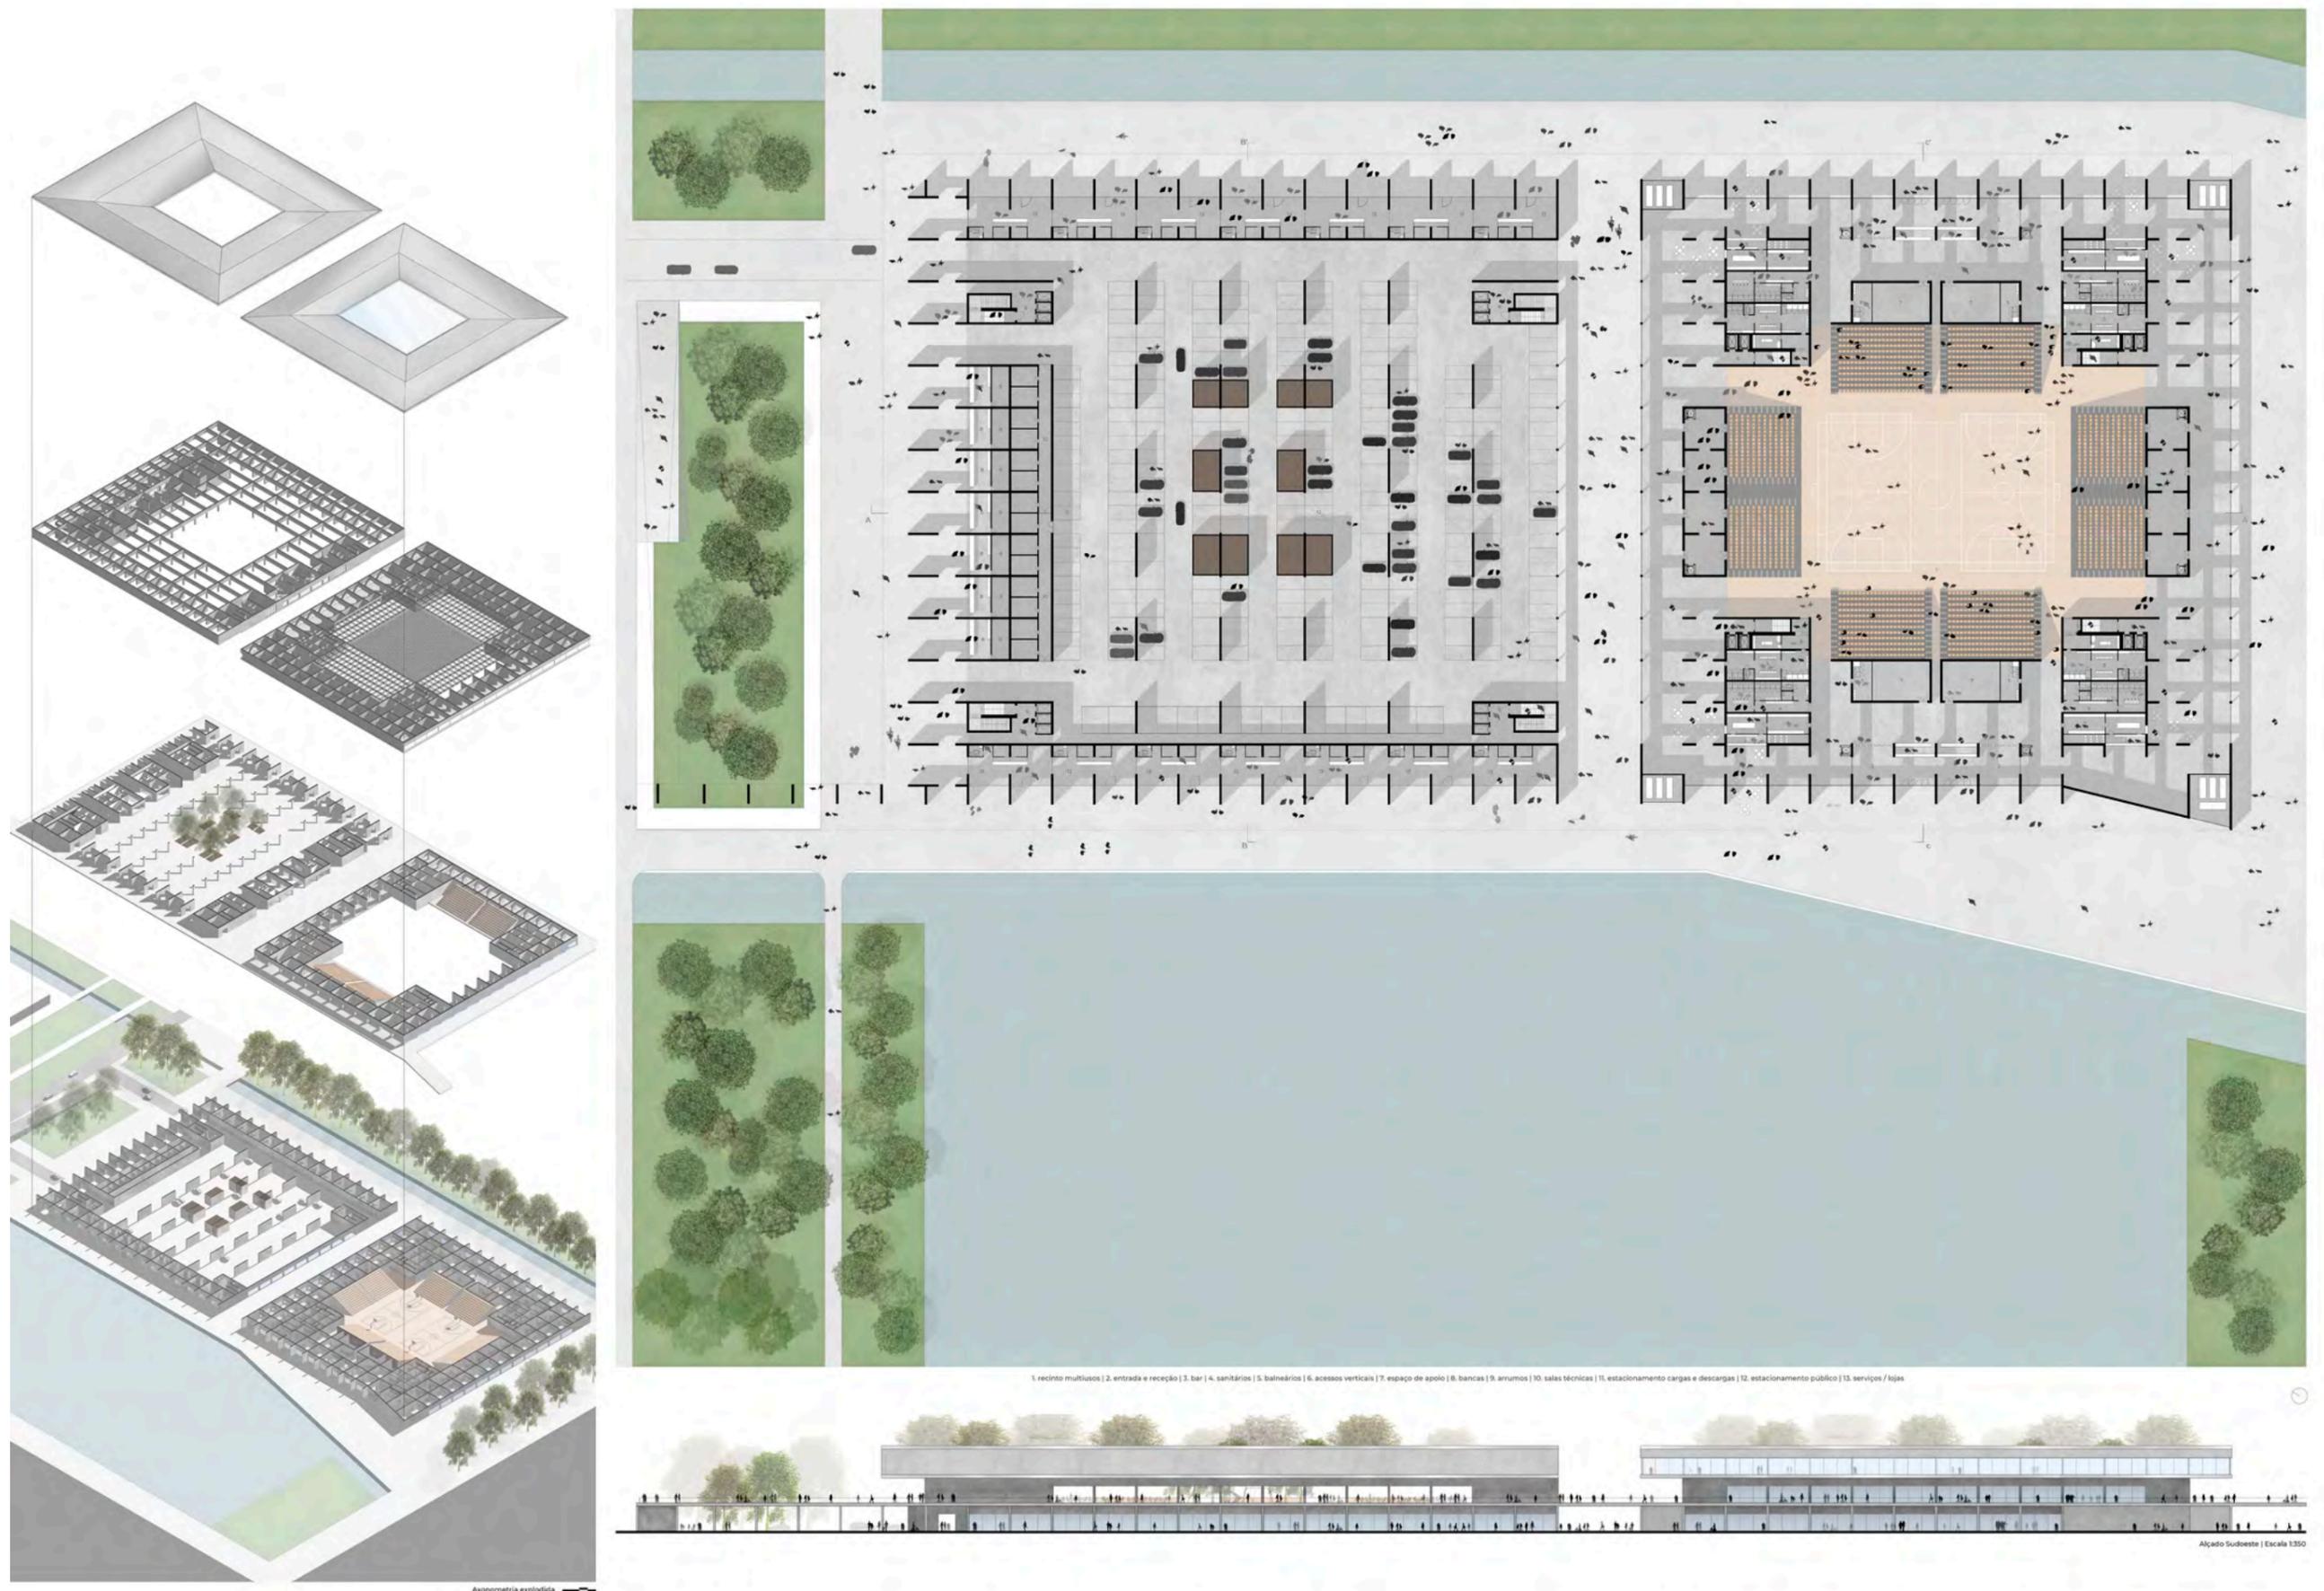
| Proposta Individual: Axonometria explodida | Planta piso térreo | Alçado Sudoeste (ver Painel A0 em anexo)
